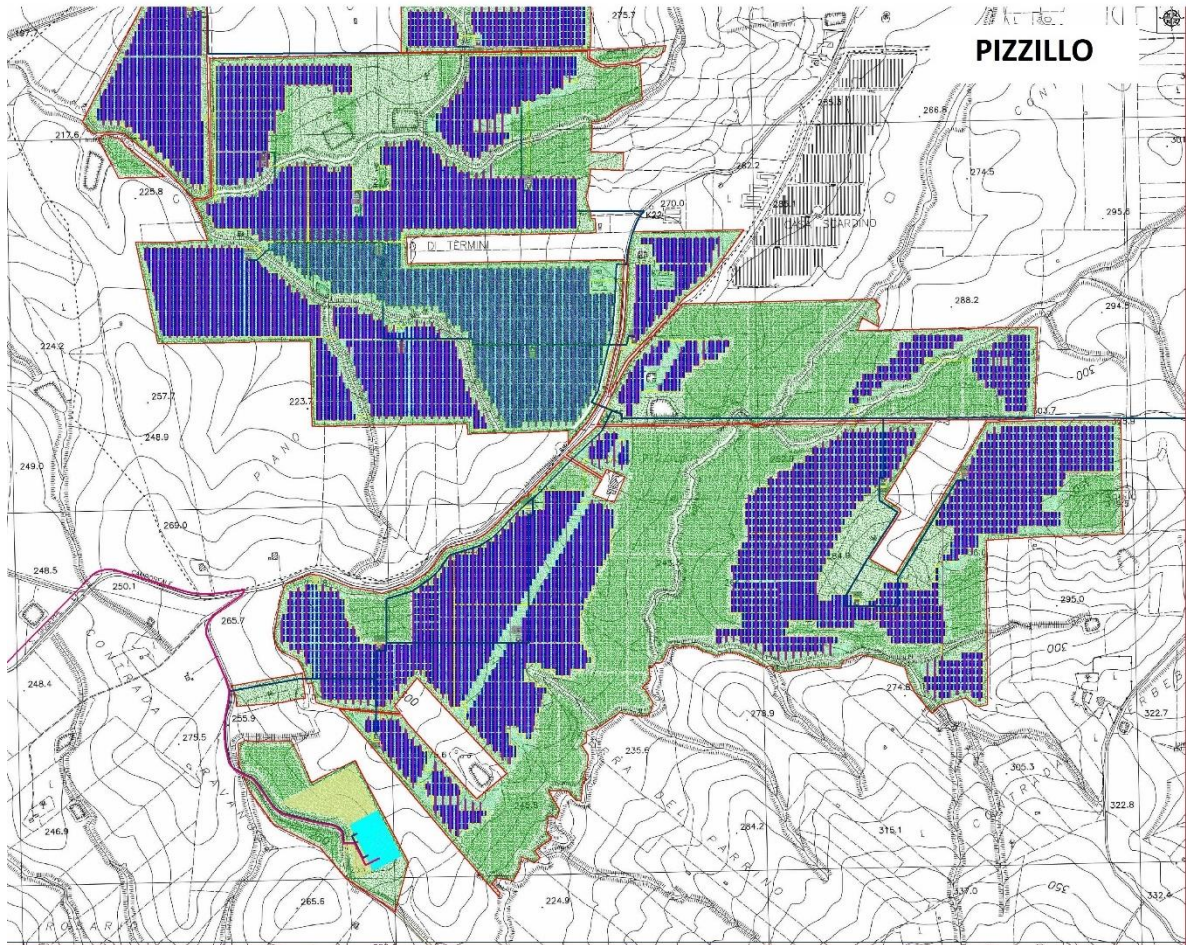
B– Layout dell’area d’impianto ricadente sul territorio di Monreale e Camporeale (PA) -contrada Pizzillo e stazione smistamento con cavidotto
